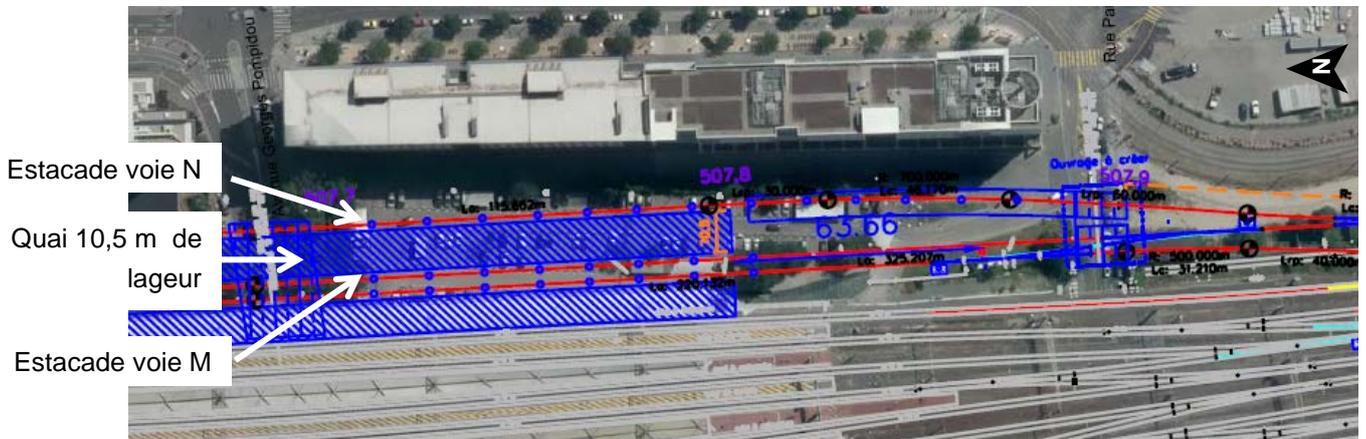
Coupe de l'ouvrage prévu dans l'EP voie L et nouveaux ouvrages
